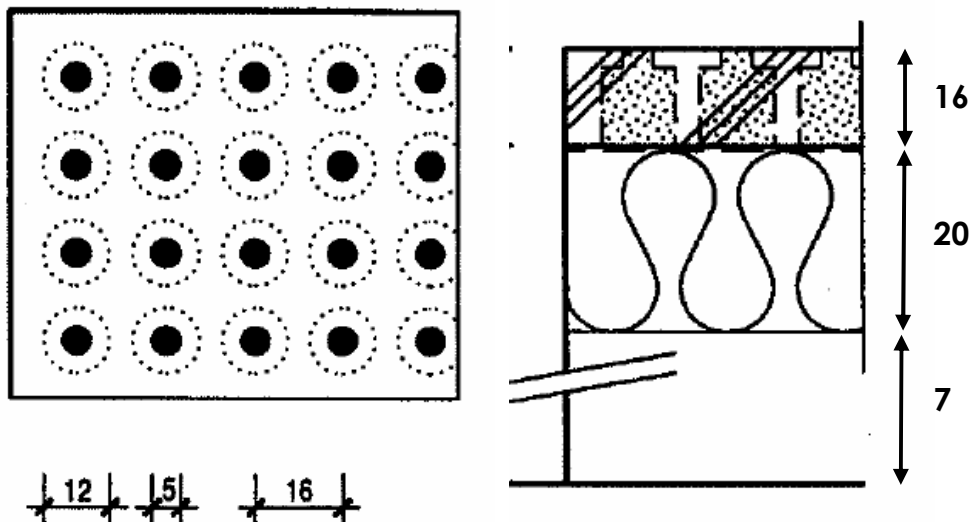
Pannelli fonoassorbenti tipo Patt STILLWALL 12/5
